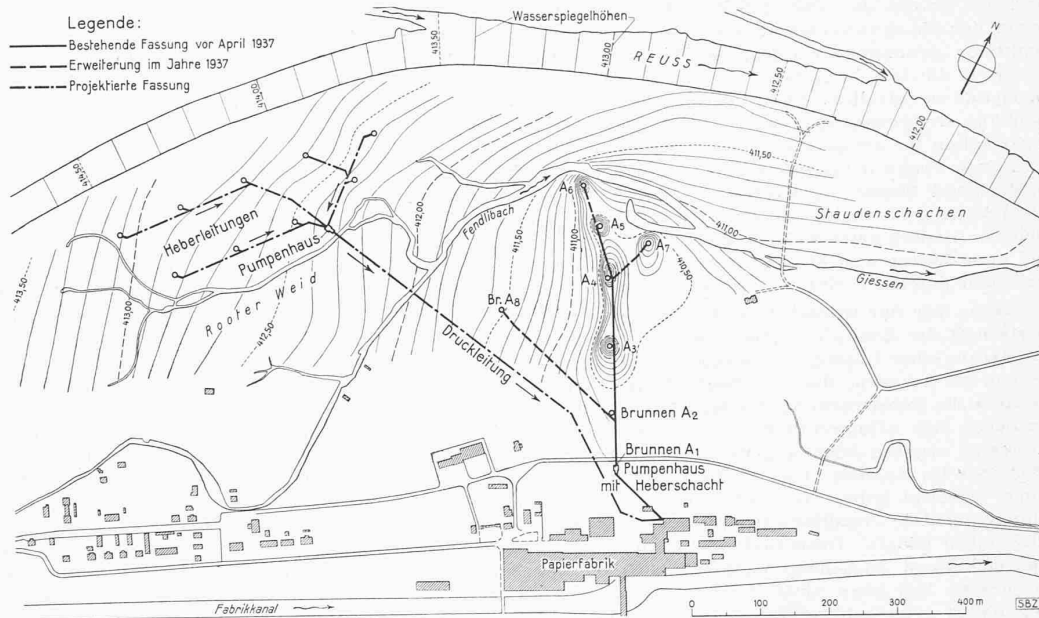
Grundwasserversorgung der Papierfabrik Perlen. Lageplan 1: 10000 mit Betriebswasserspiegel bei voller Beanspruchung der bestehenden Grundwasser-Fassung (nach der Erweiterung von 1937)
